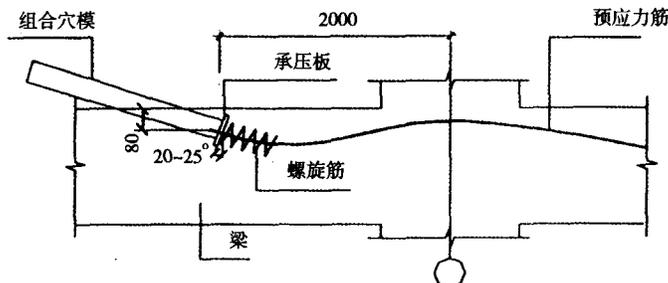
梁内缓粘结预应力筋梁面张拉端节点大样
